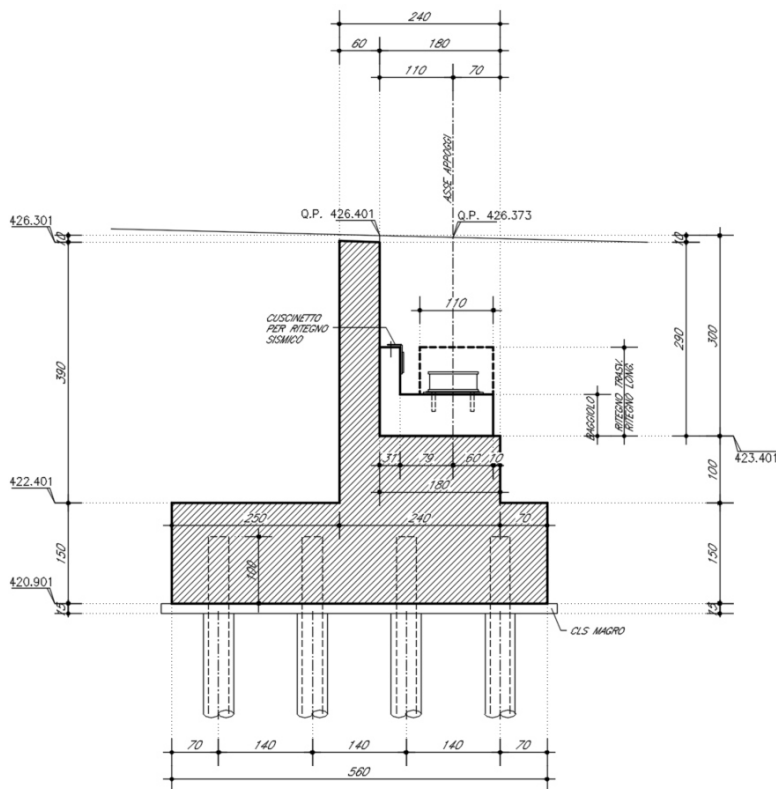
Sezione in asse tracciamento spalla A
